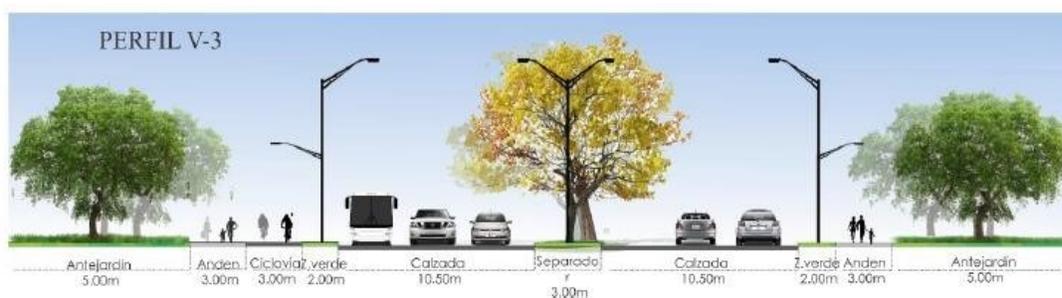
Perfil propuesto para la Avenida Puerto López
